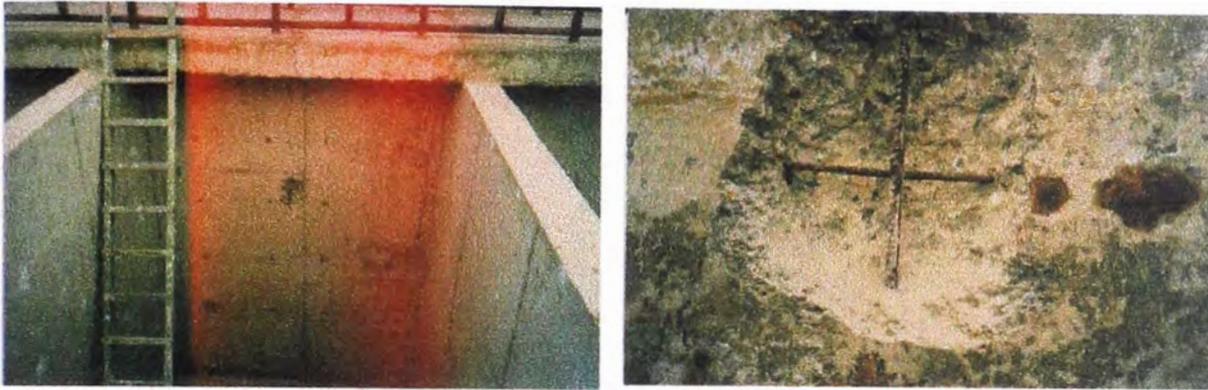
A la izquierda picado por la parte interior de los tanques. A la derecha un acercamiento del picado en el que se aprecia el excelente estado de la armadura.
